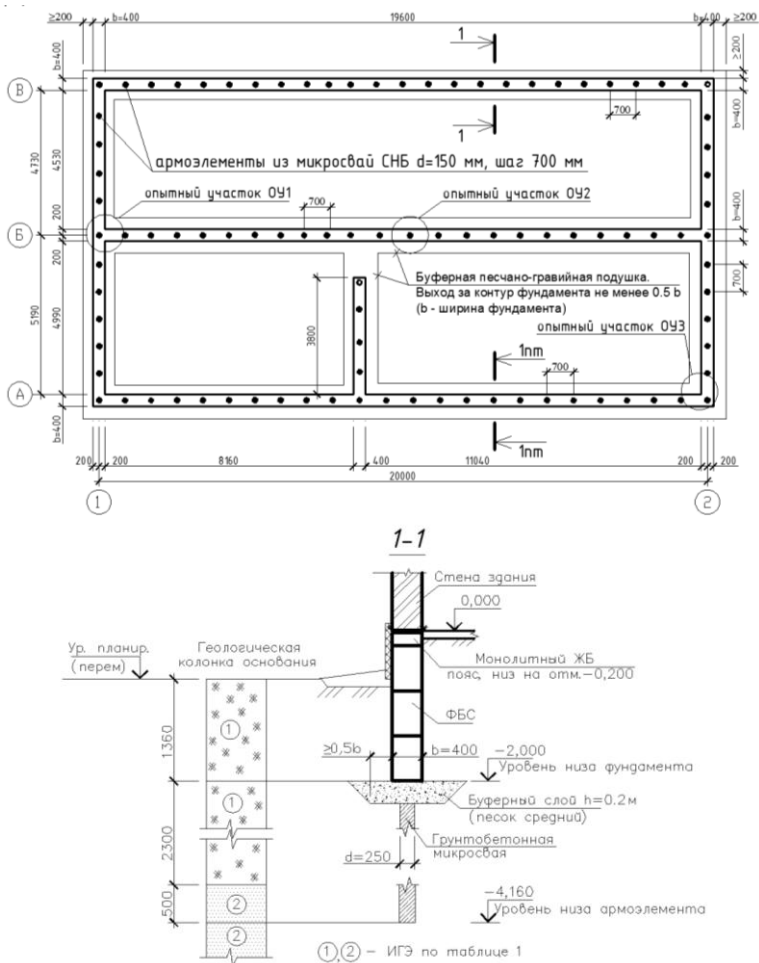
Схема-план фундаментов и геомассива здания (с расположением армоэлементов)
